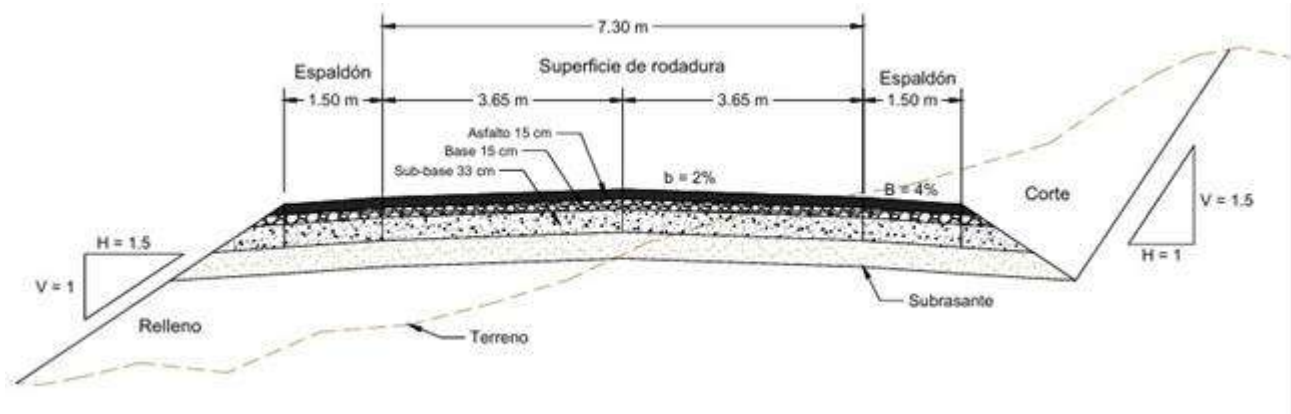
Sección transversal de la vía con la estructura de pavimento flexible.
